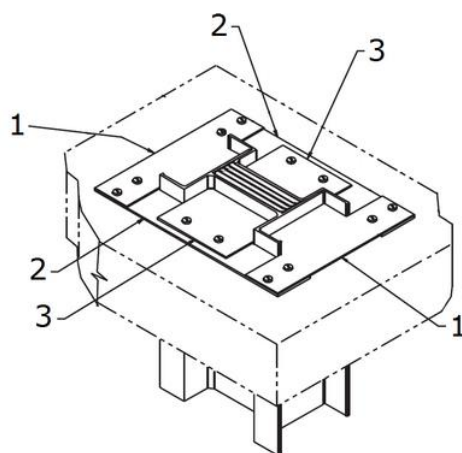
Схема крепления пластин для закрытия отверстия в этажном перекрытии: 1 – боковые пластины; 2, 3 – фронтальные нижняя и верхняя пластины
